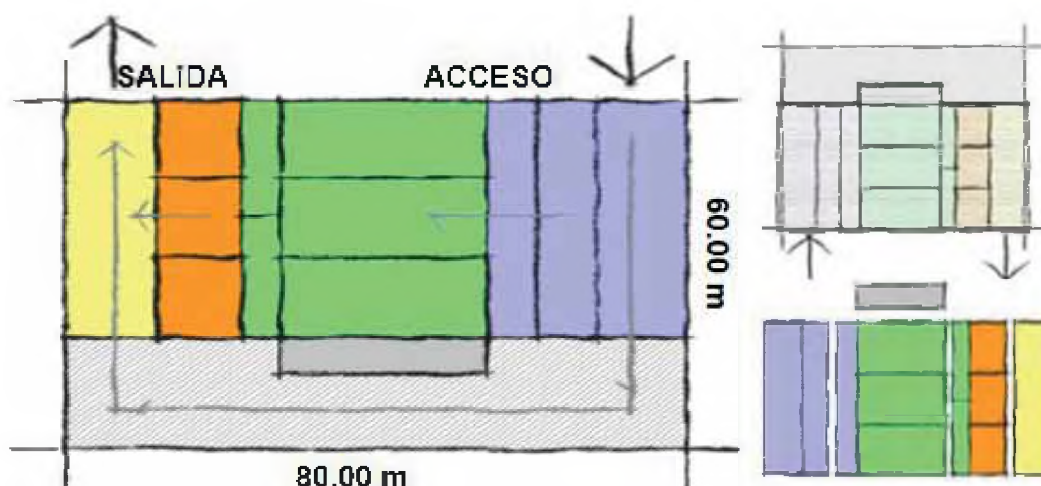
Esquemas en planta de alternativa 3. Fuente: elaboración propia
